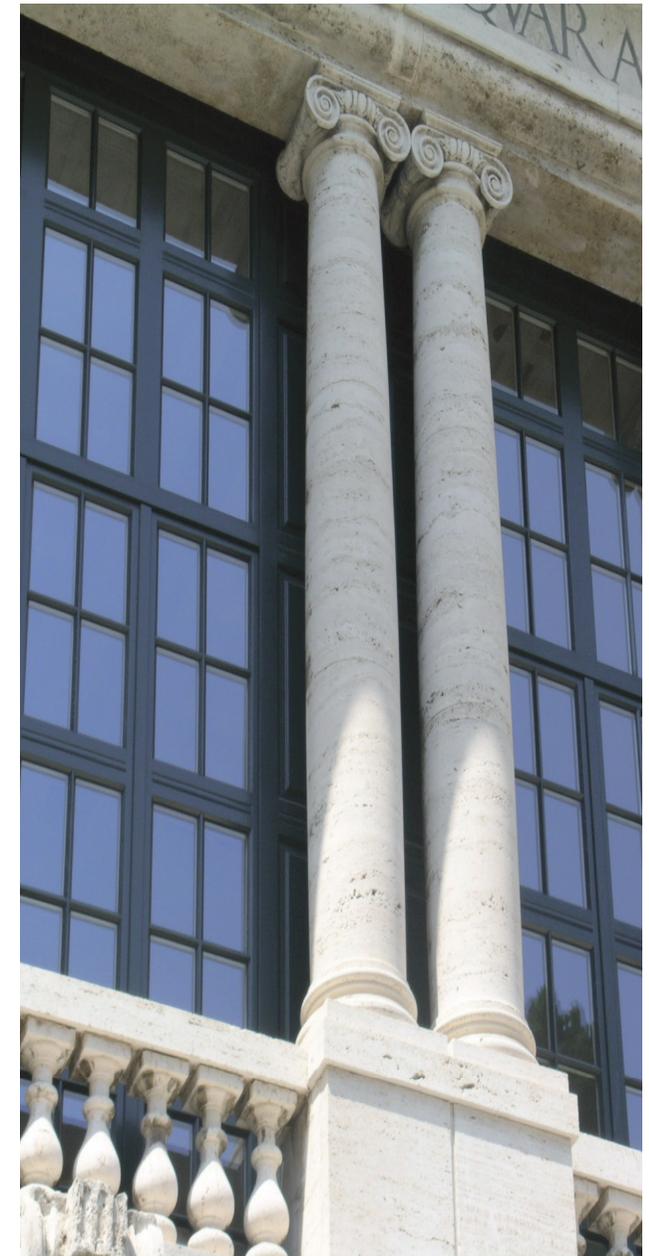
Außenansicht Fensterelement Salone/Haupthaus
